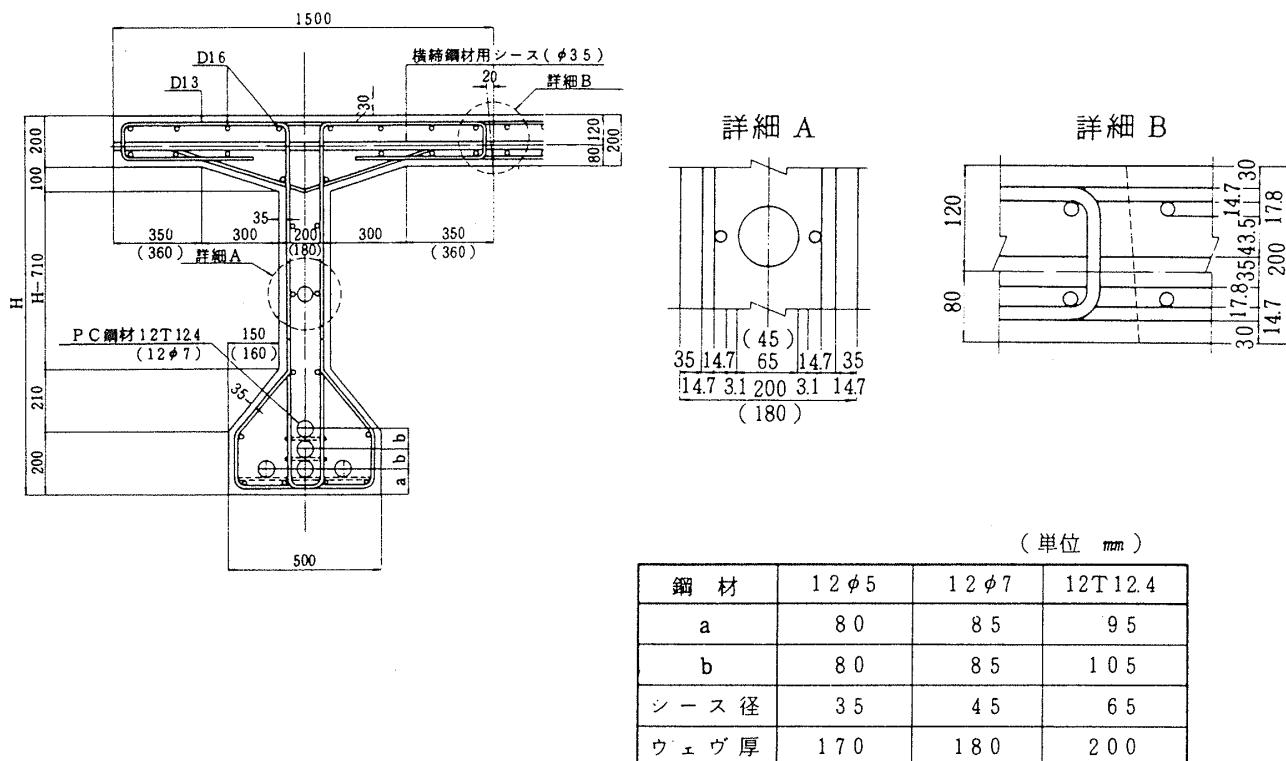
主げたの形状寸法と鋼材配置³⁴⁾
